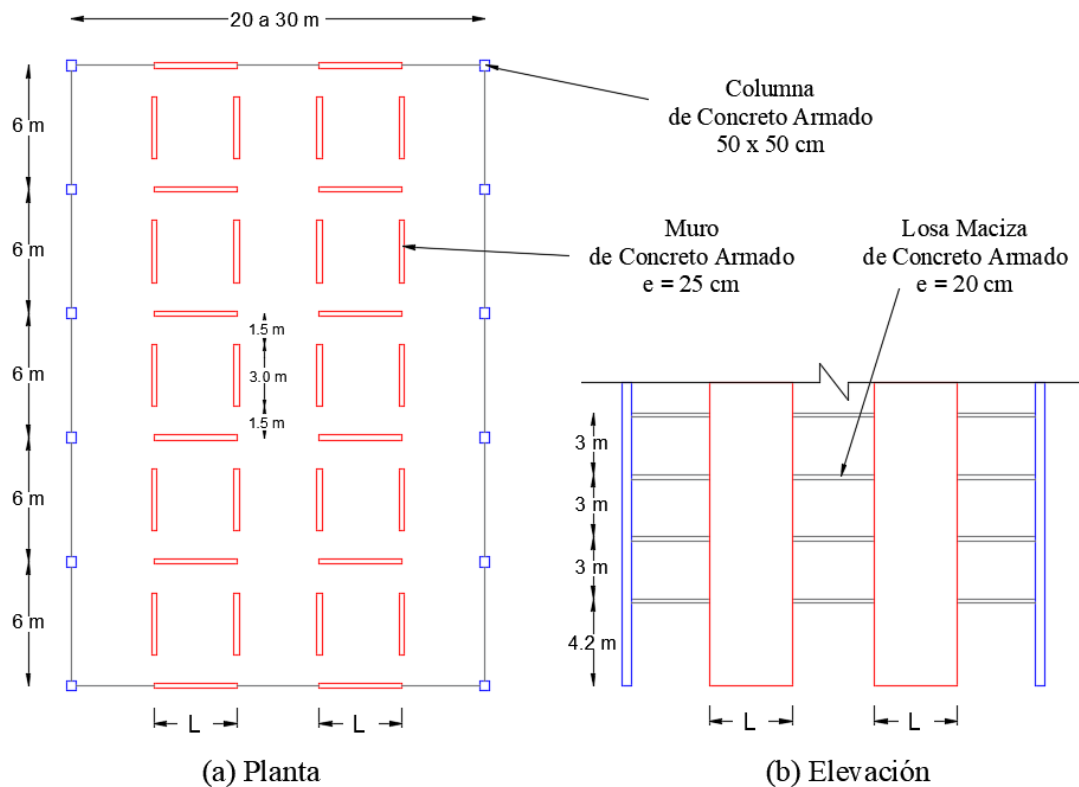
(a) Planta y (b) elevación del edificio de concreto armado.
